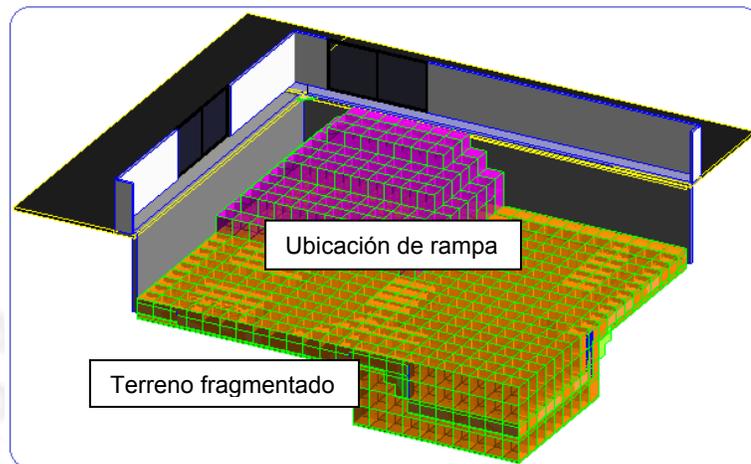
Modelo de terreno fragmentado para excavación.
